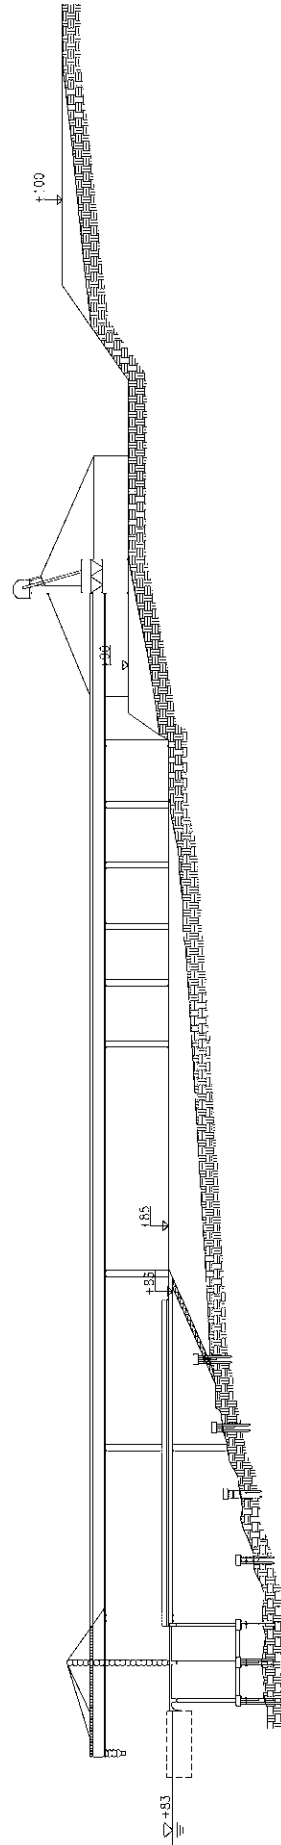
Plano de las Sección Transversales de las Instalaciones
